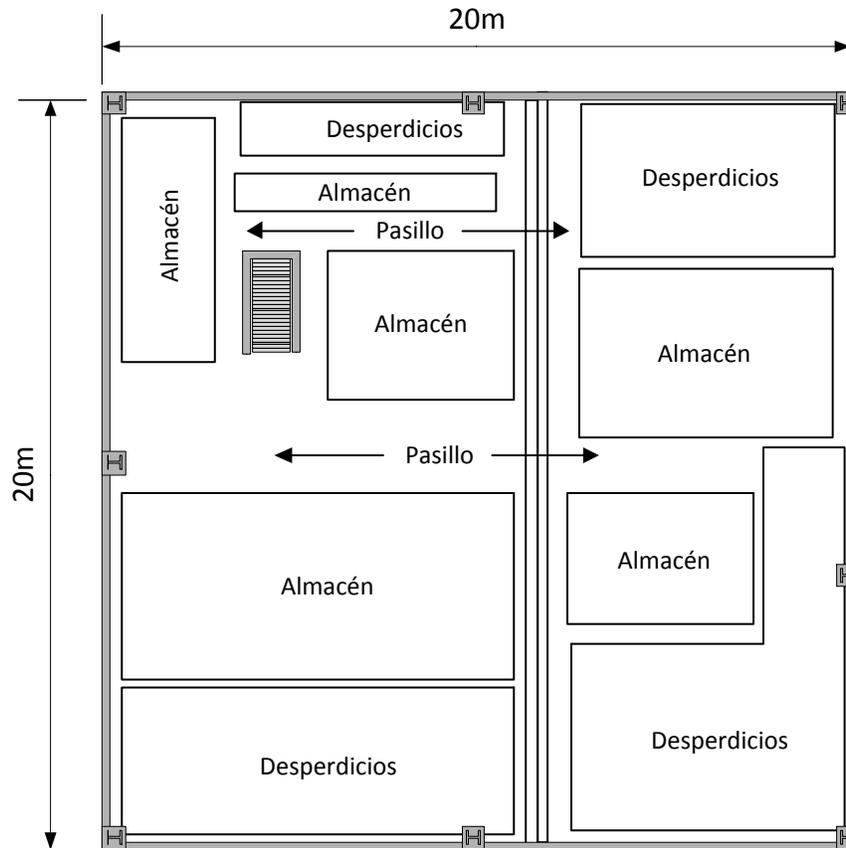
Vista de planta de la distribución actual del segundo nivel.
